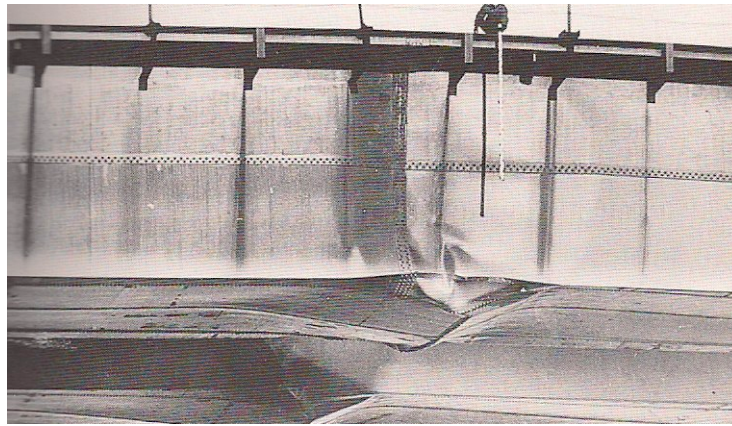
4ª Ponte sobre o Danúbio após ocorrer a falha
